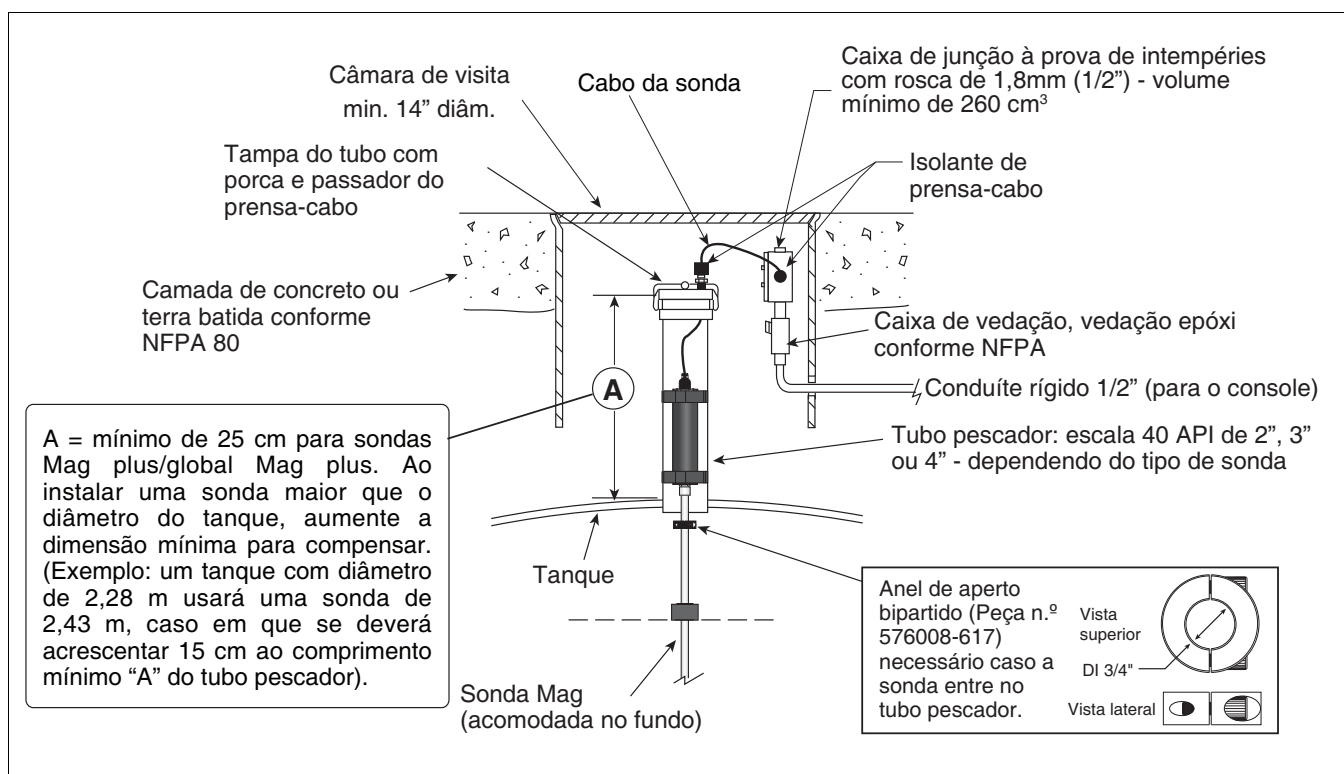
Instalação de sonda em tanque subterrâneo - Tubo pescador dedicado
